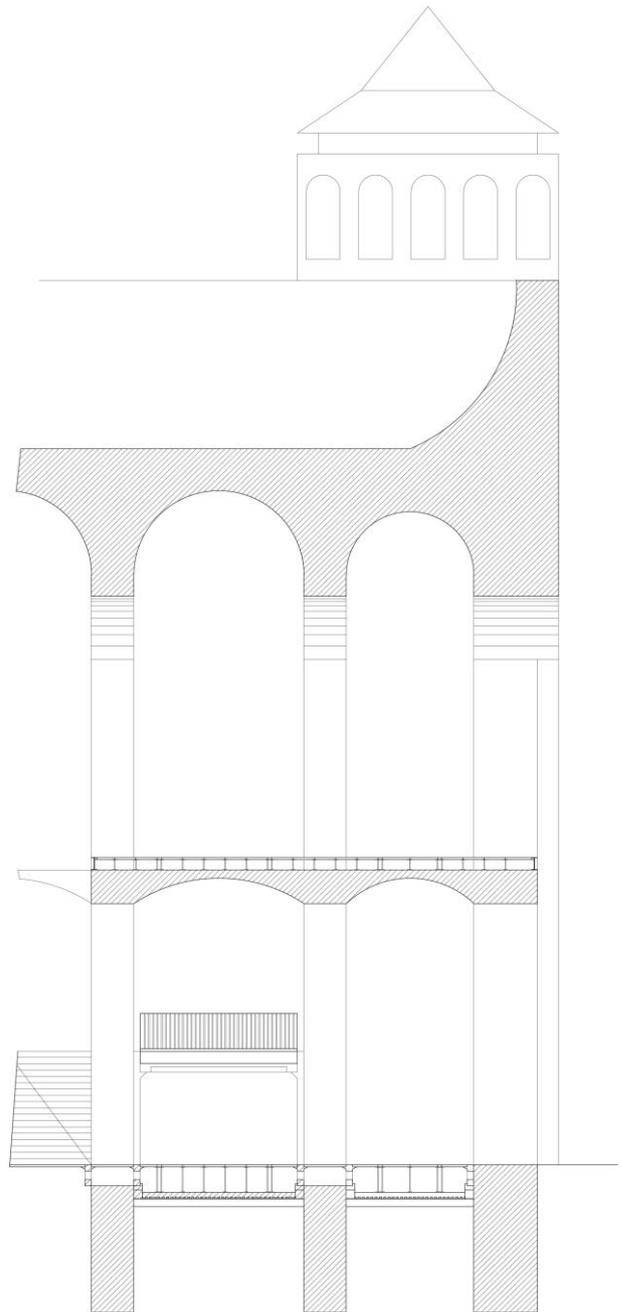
CLOTET-PARICIO, Sección detalle proyecto
